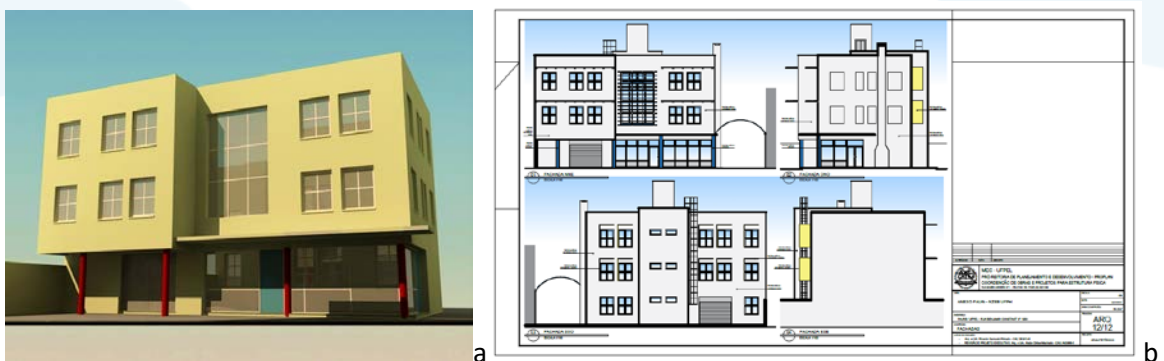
a) croquis digital inicial do prédio proposto no pátio da FAUrb; b) prancha de fachadas do projeto executivo, na proposta ANEXO FAUrb - NZEB UFPel.
